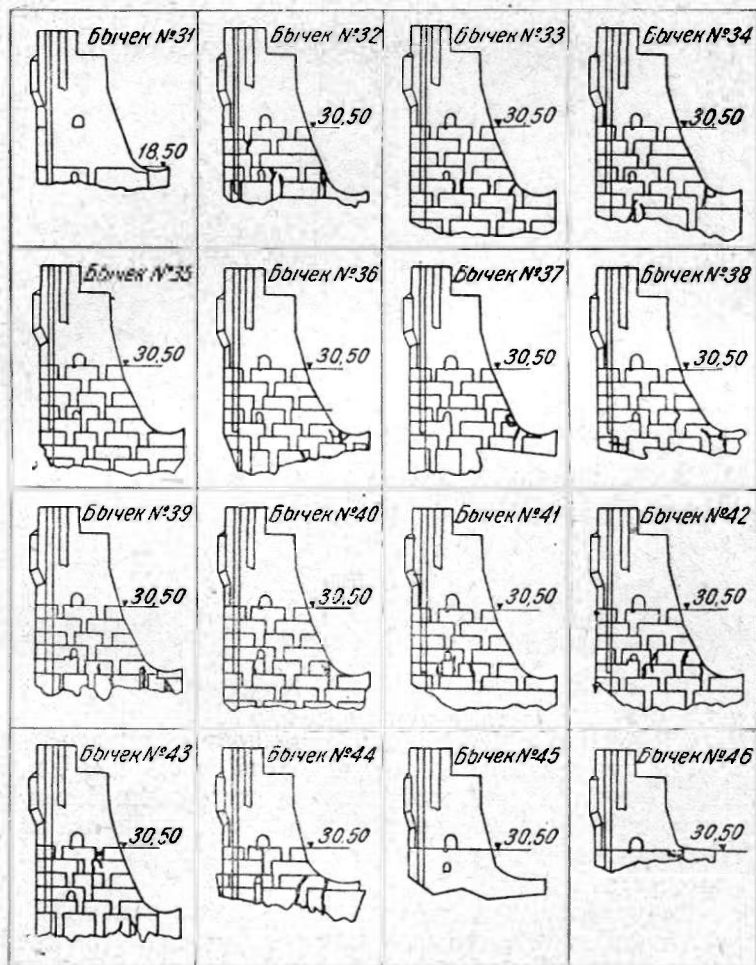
Начальная схема разбивки на блоки бетонной кладки бычка и пролета (1929 г.).
